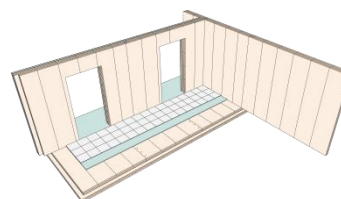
SOLUÇÃO A: Pormenor construtivo
